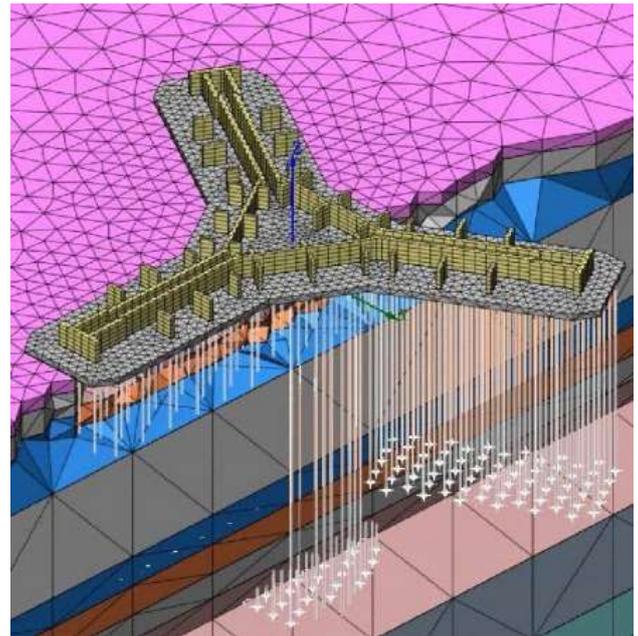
Фрагмент расчетной модели высотного здания с выделением основных несущих элементов в уровне заделки свай переменной длины в фундаментную плиту
